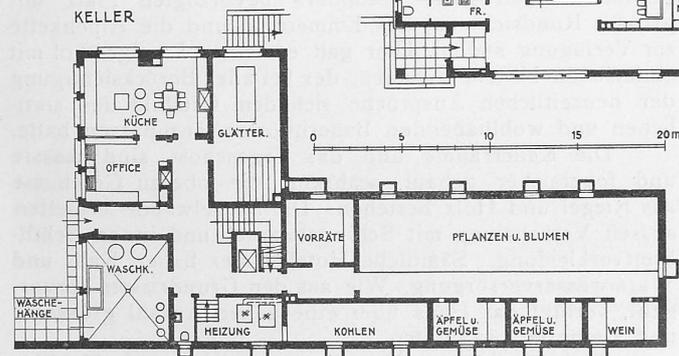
bis 5. Grundrisse des Greisenasyls Burgdorf. — Masstab 1 : 400.
